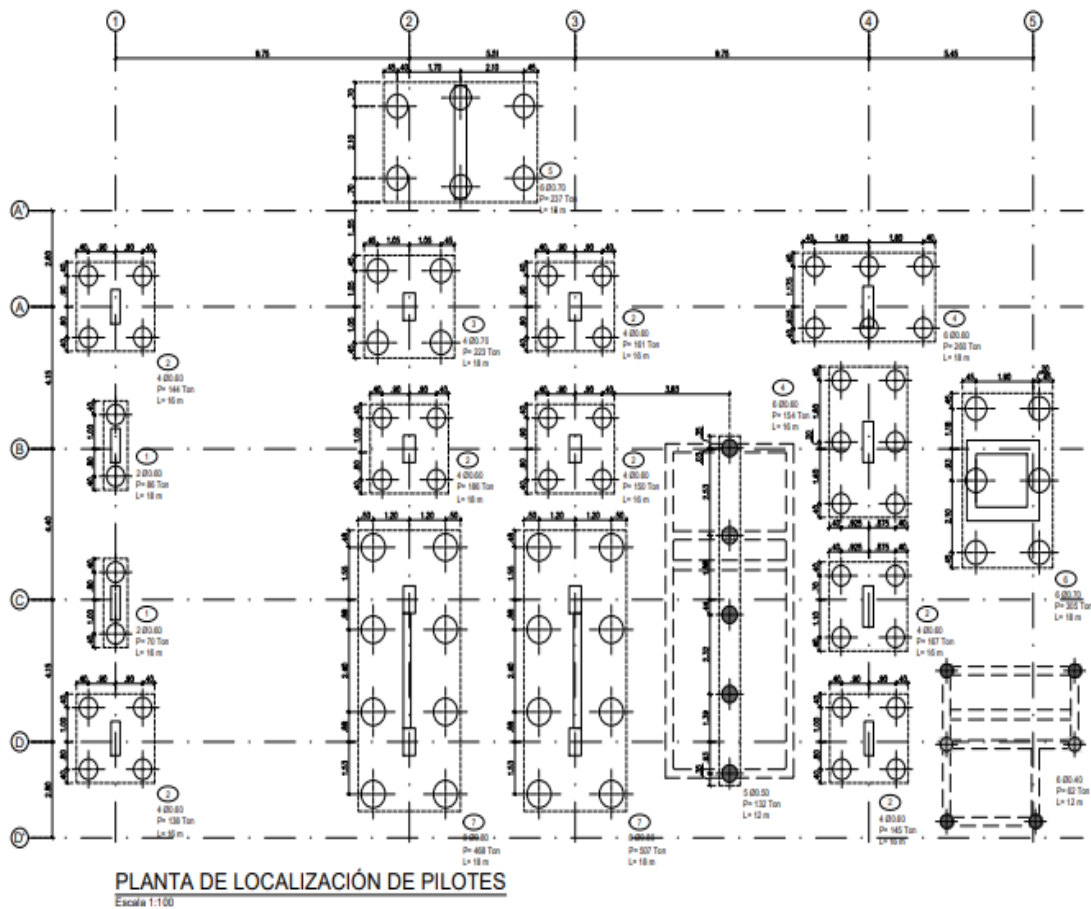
Plano en planta de cimentación<sup>17</sup>
